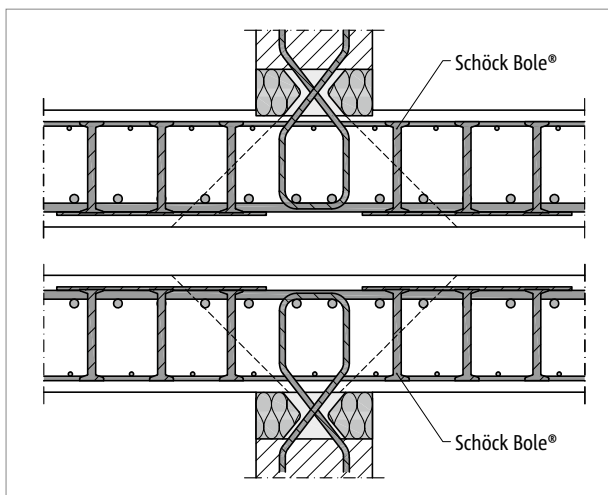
Schöck Sconnex® Typ W-N: Indirekte Lagerung der Schöck Sconnex®, mit Schöck Bole® bewehrt
